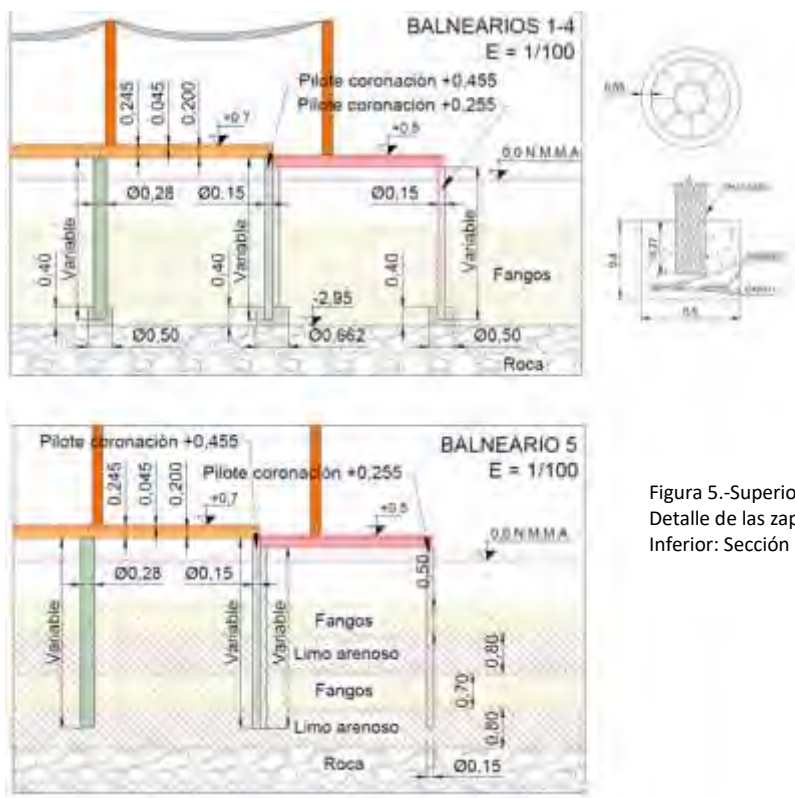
Superior: Esquema de cimentación para balnearios del 1 al 4. Detalle de las zapatas (der.) y sección de cimentaciones sobre roca. Inferior: Sección pilotes hincados en terreno arenoso.
